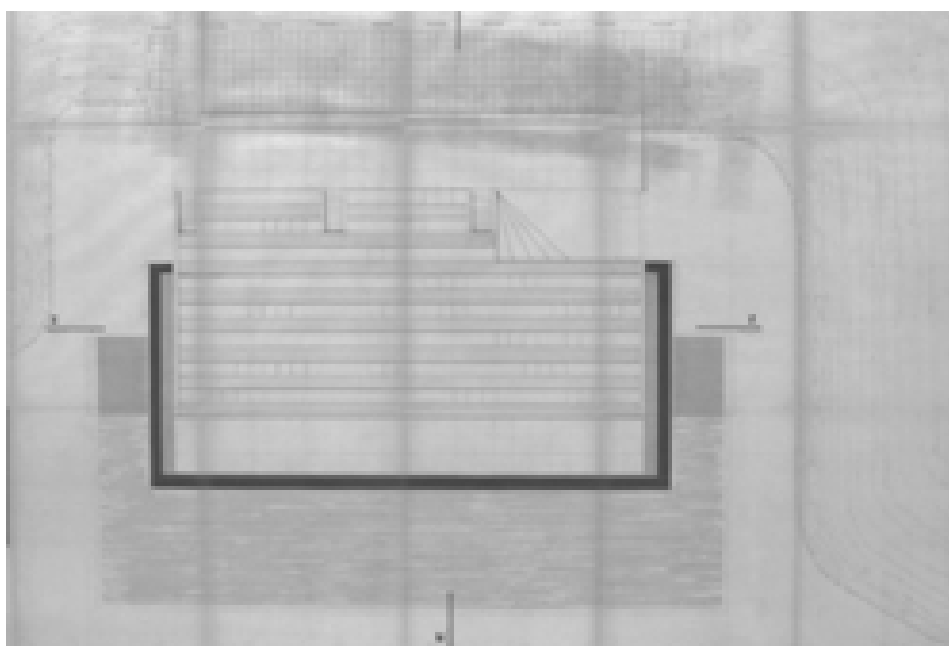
Pianta delle coperture, progetto di massima, 1973/1974 (AABS-162)
